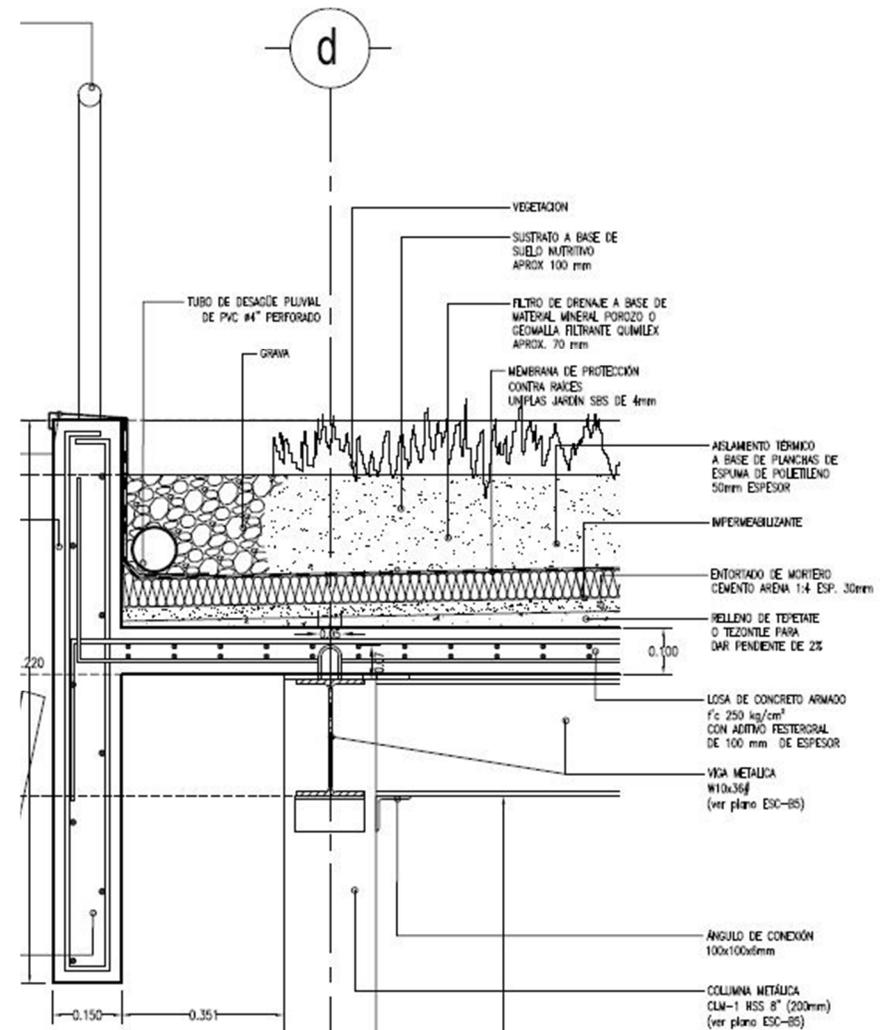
Corte por Fachada del plano ESC-B9 donde se muestran los elementos del sistema constructivo
